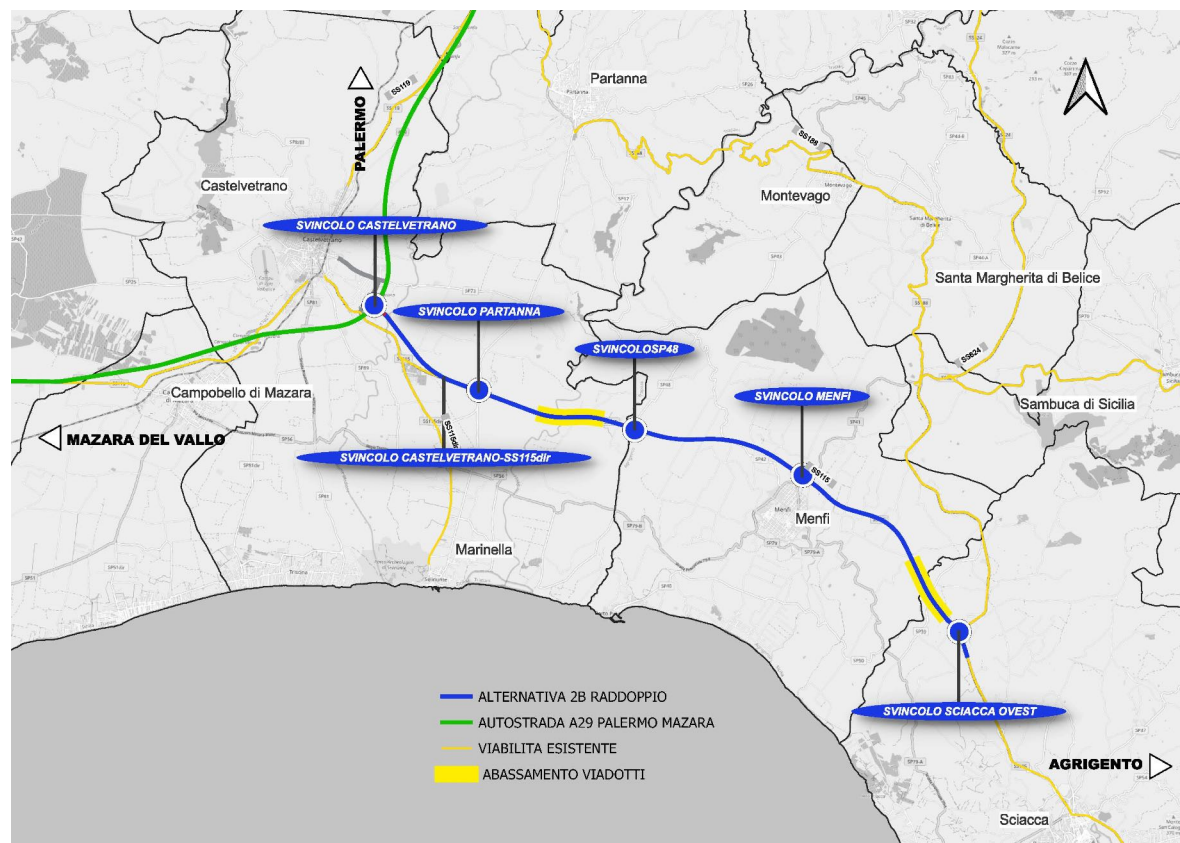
10 – Planimetria e profilo di progetto – Alternativa 2B
